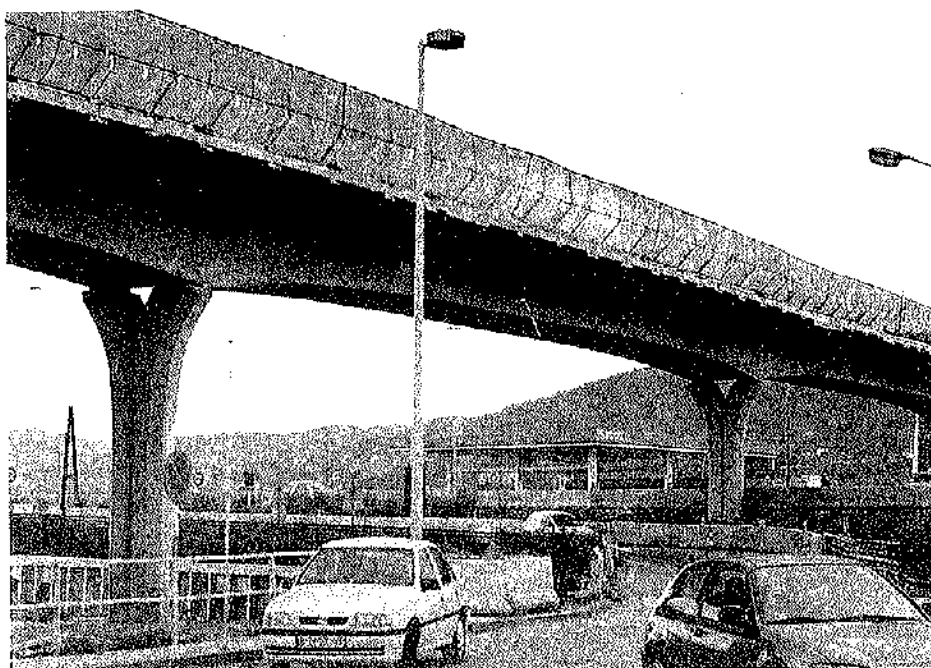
Paso sobre autopista A-7 en Molins de Rey (Barcelona). Luces: 18,50 - 43,50 - 41,00 - 15,00 m. Prefabricación total de pilas, viga artesa y prelosas del tablero con ancho de 12,00 m.
